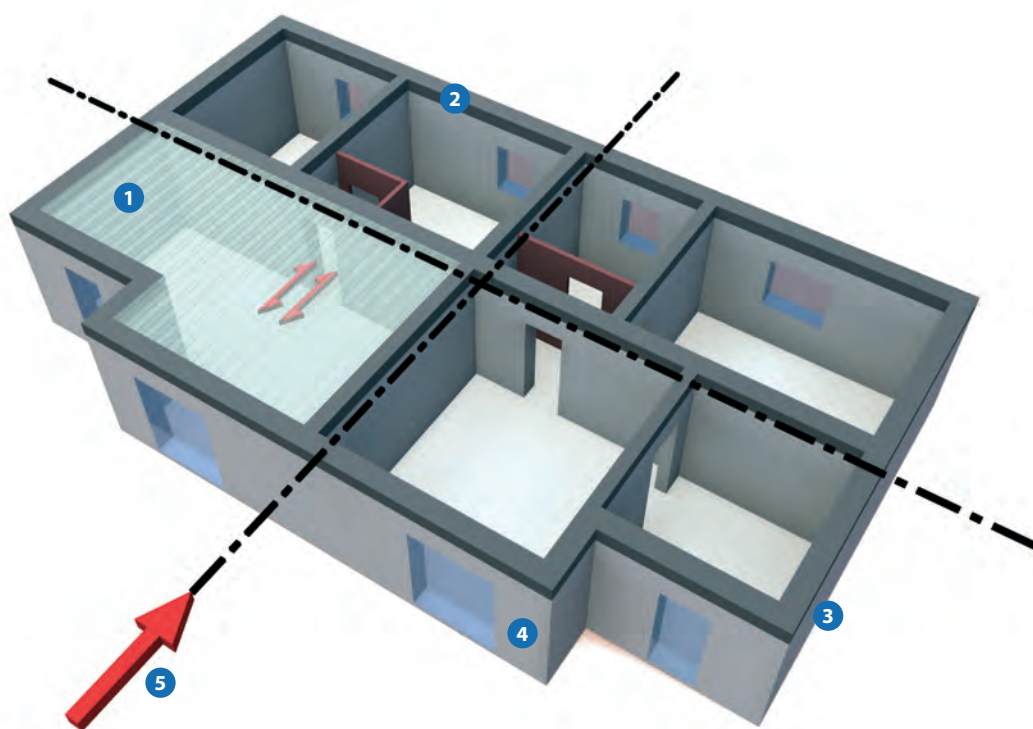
Schema strutturale di un edificio in muratura portante
